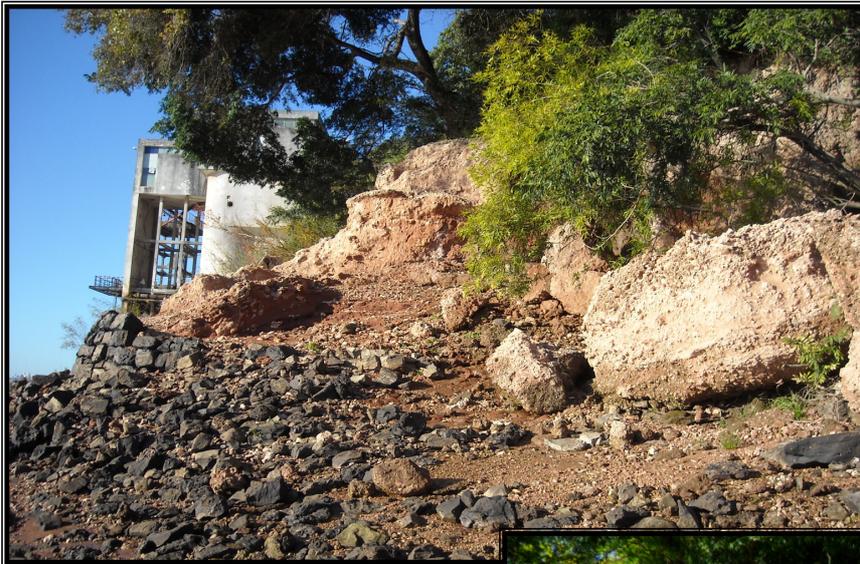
vista lateral del deterioro del espigón (orientación de fotografía Sureste)
